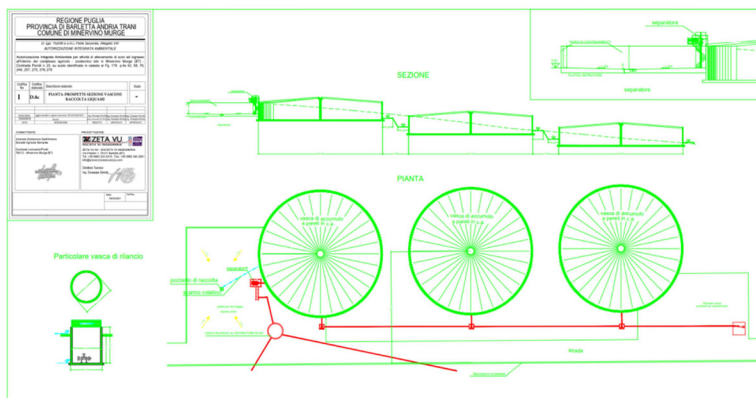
Elaborato D-8c REV. 19.03.2021 – Pianta prospetti sezione vasconi raccolta liquami
